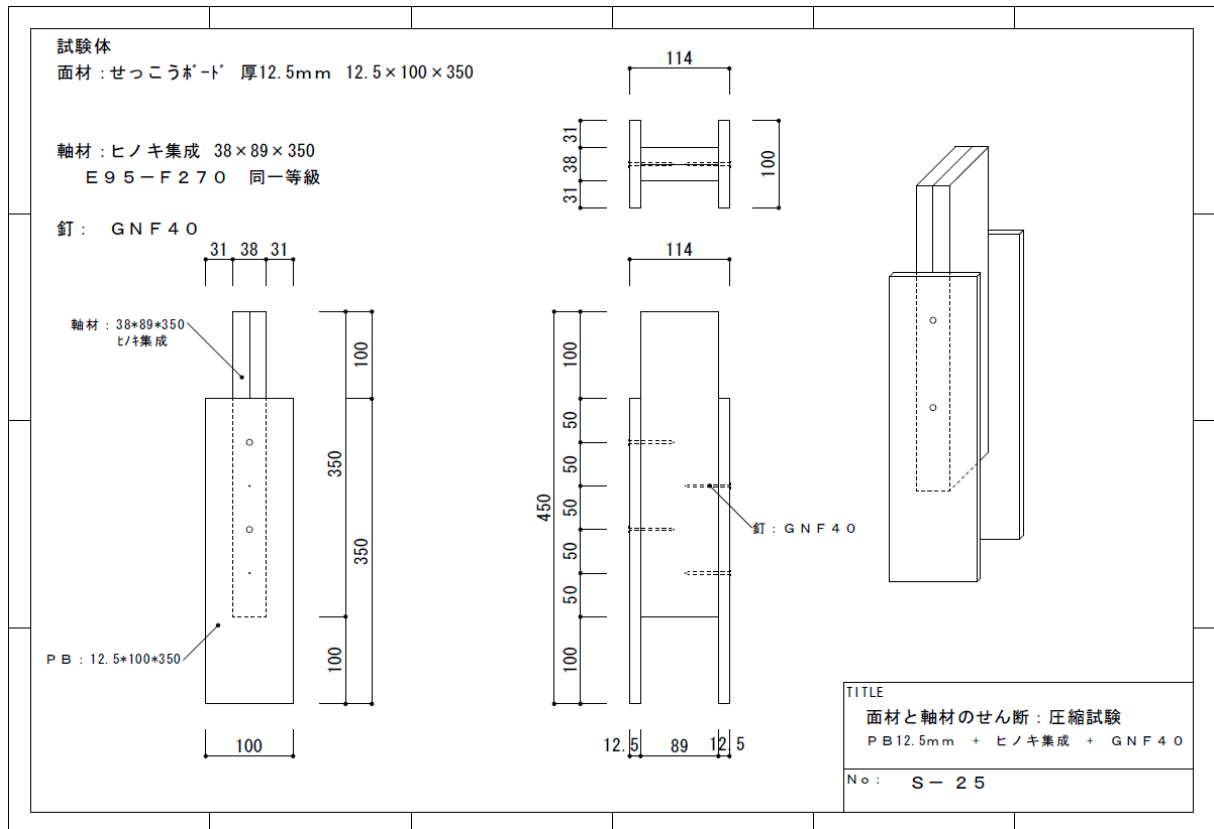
S-25 試験体図 (石膏ボード 12.5mm)
